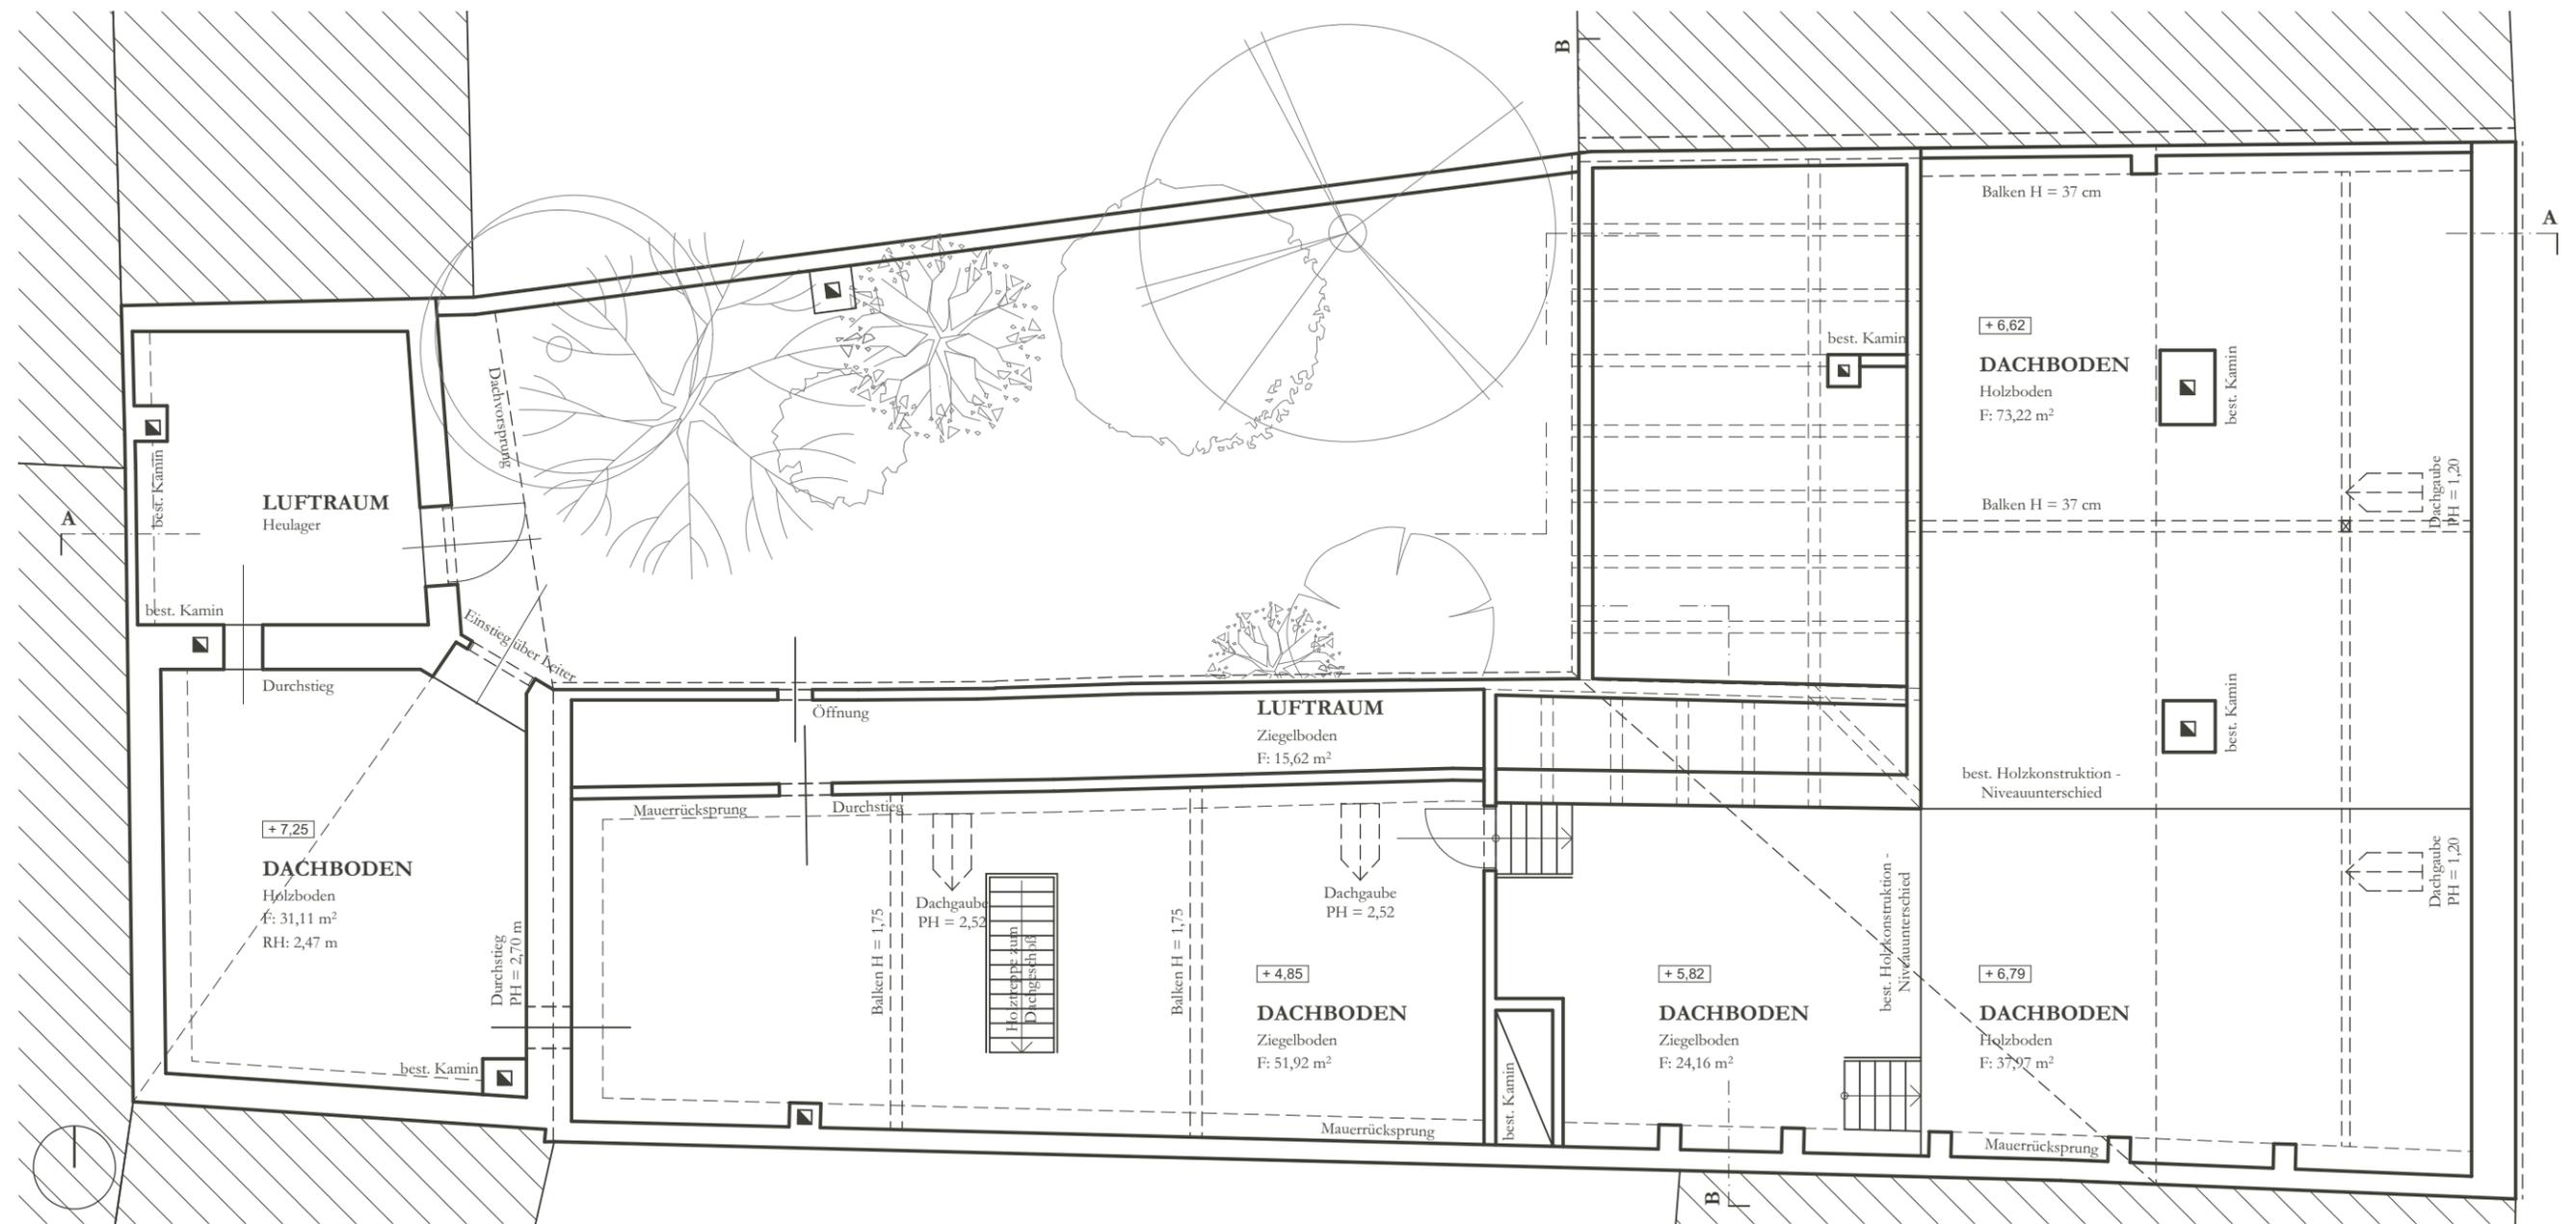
Bestandsplan Dachgeschoß, M 1:100
